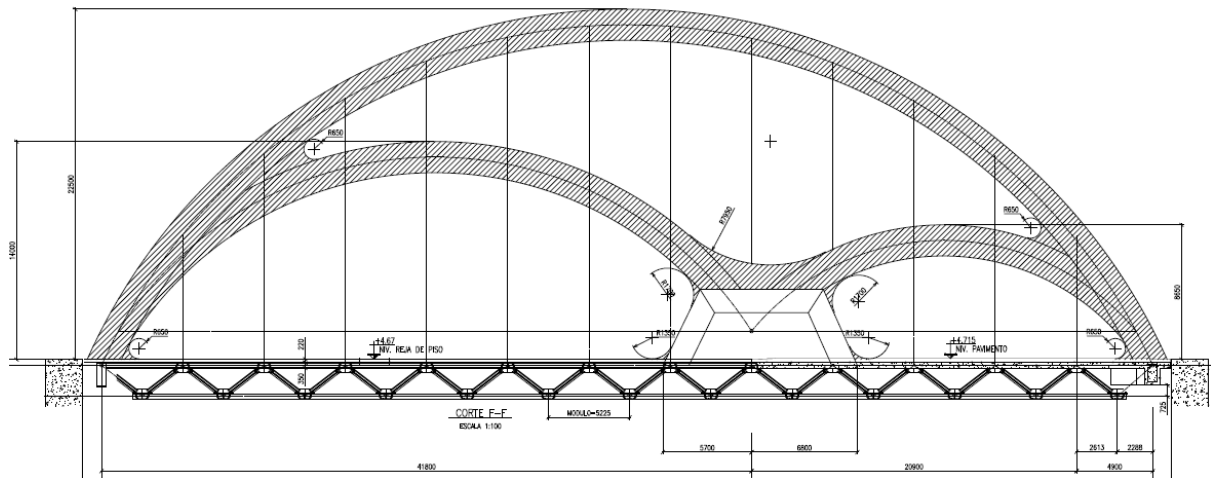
Corte sobre el eje longitudinal de la estructura del puente.
